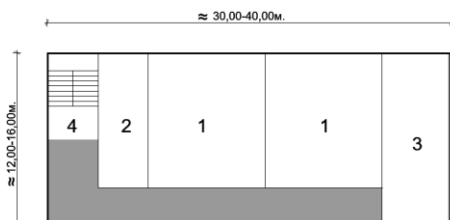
Блокова/безкоридорна планировъчна схема на едноетажна казарма.
